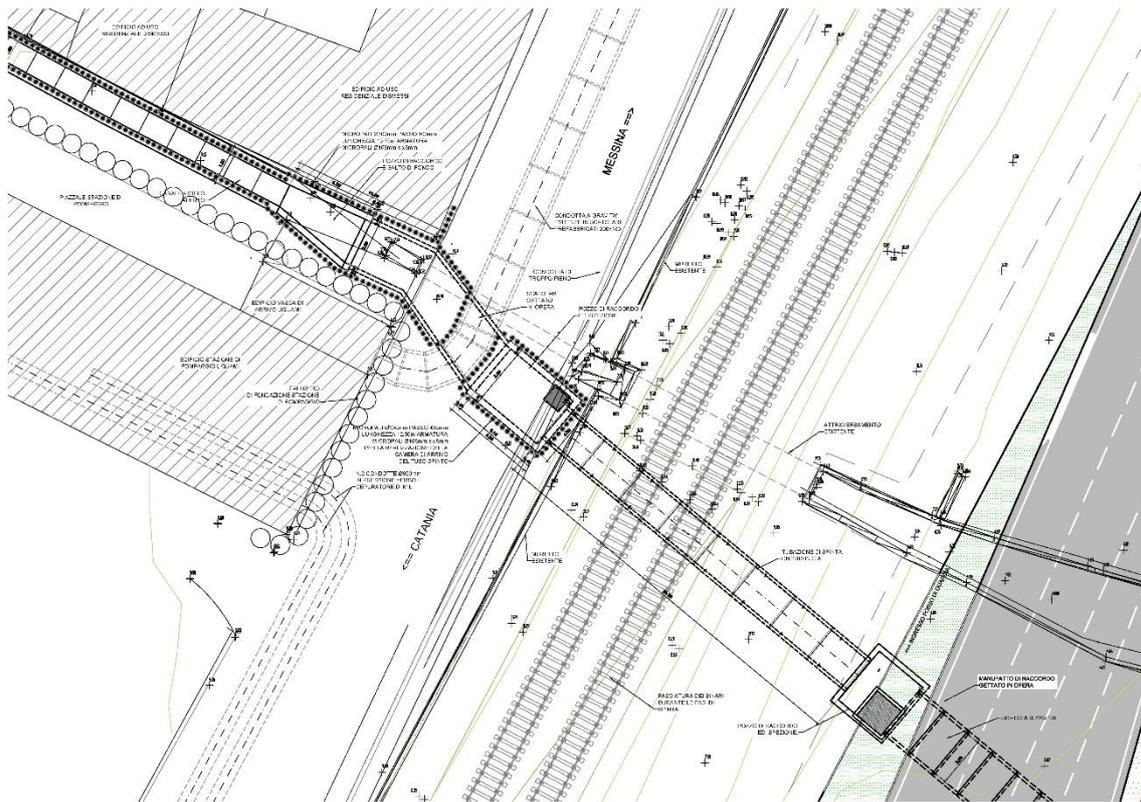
planimetria dell'attraversamento nella nuova soluzione proposta
